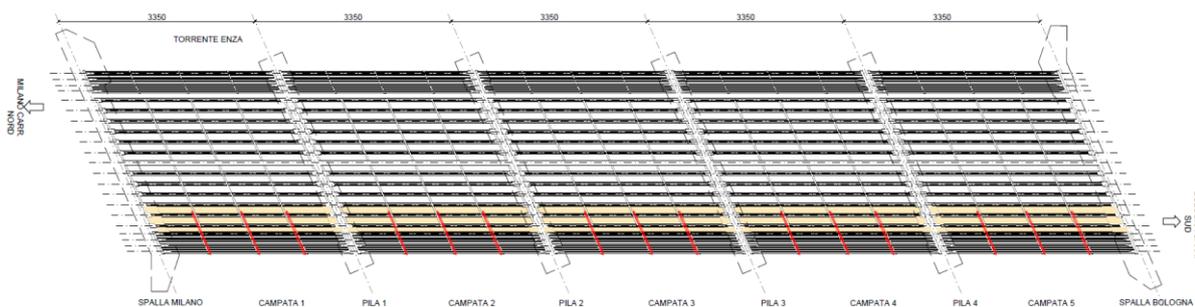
Pianta impalcato: realizzazione nuovi trasversi di collegamento (intervento 2019)
